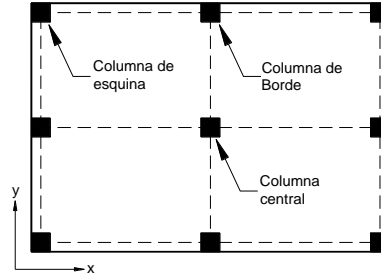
Posiciones de las columnas en la losa de cimentación
